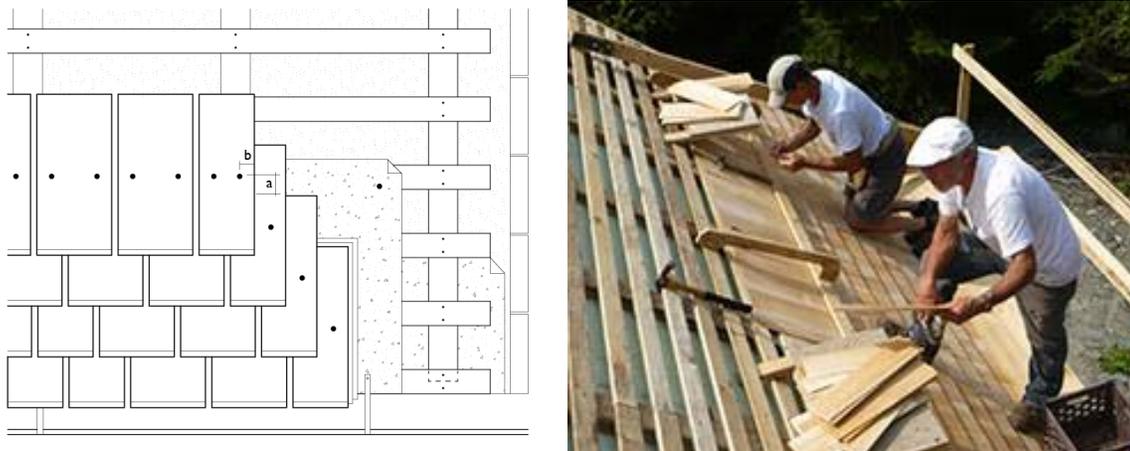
Structure et installation d'une toiture en bardeaux de cèdre
